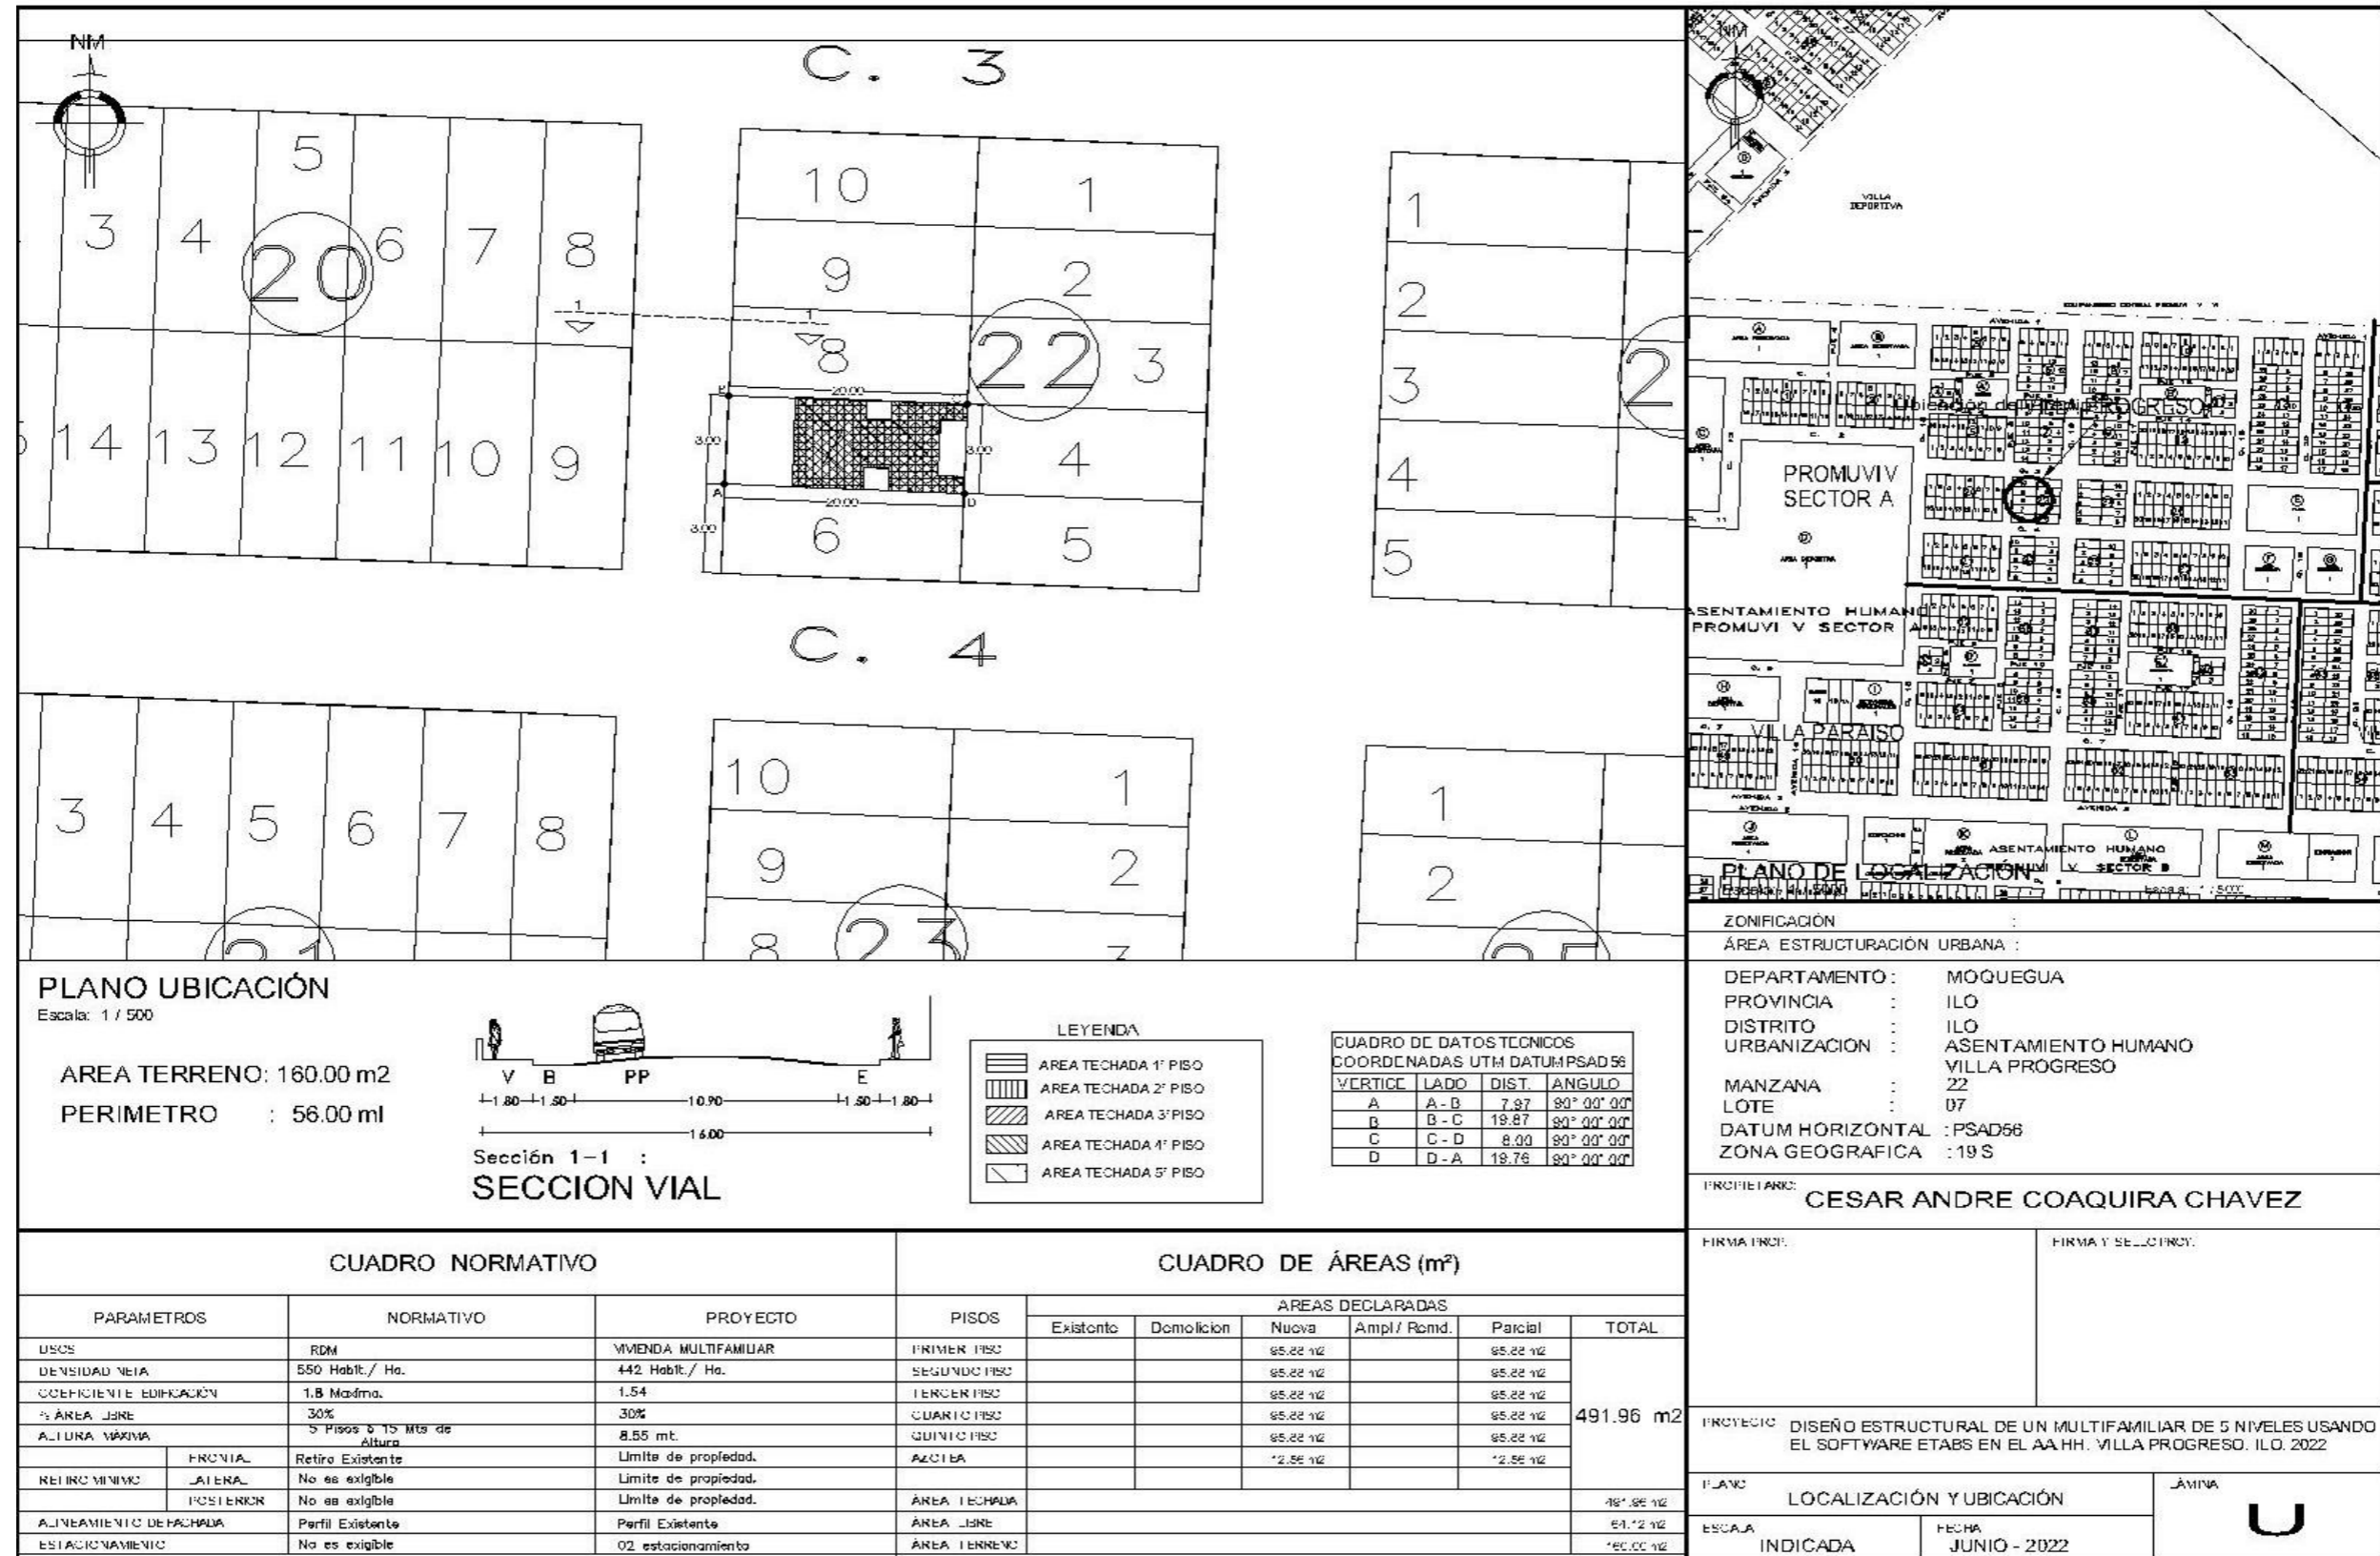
Plano de Ubicación del terreno. Elaboración propia
